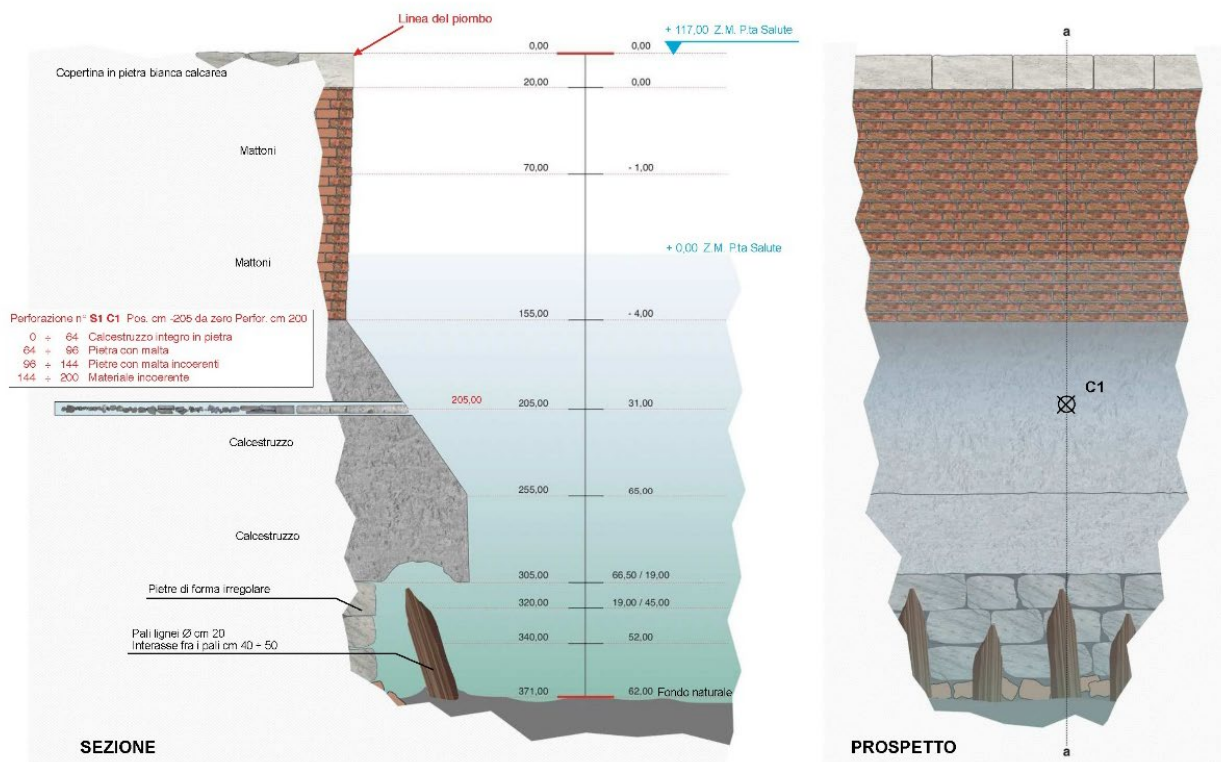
Sezione di rilievo subacqueo della fondamenta della pescheria
